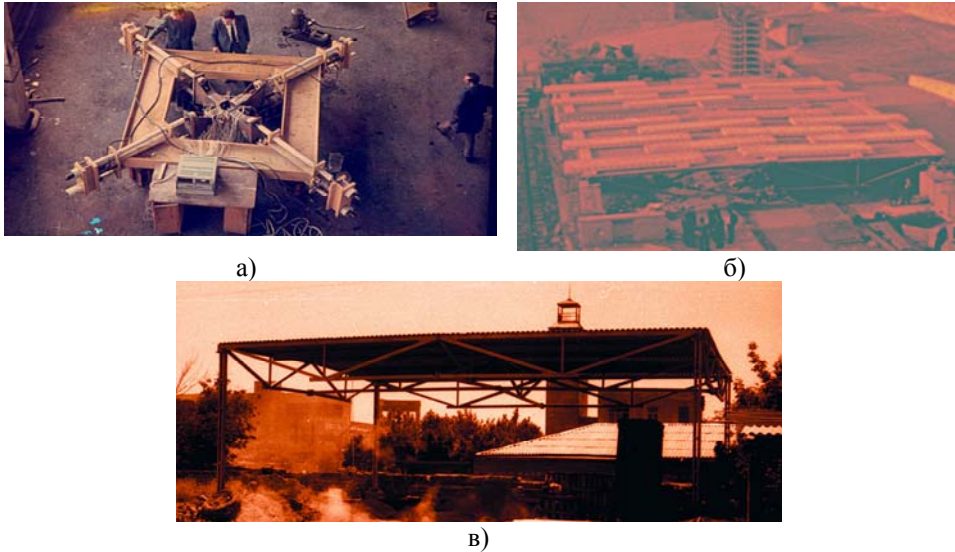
Общие виды стендовых испытаний узловых соединений (а), натуральных испытаний блока покрытия (б) и его повторного монтажа для эксплуатации на объекте
